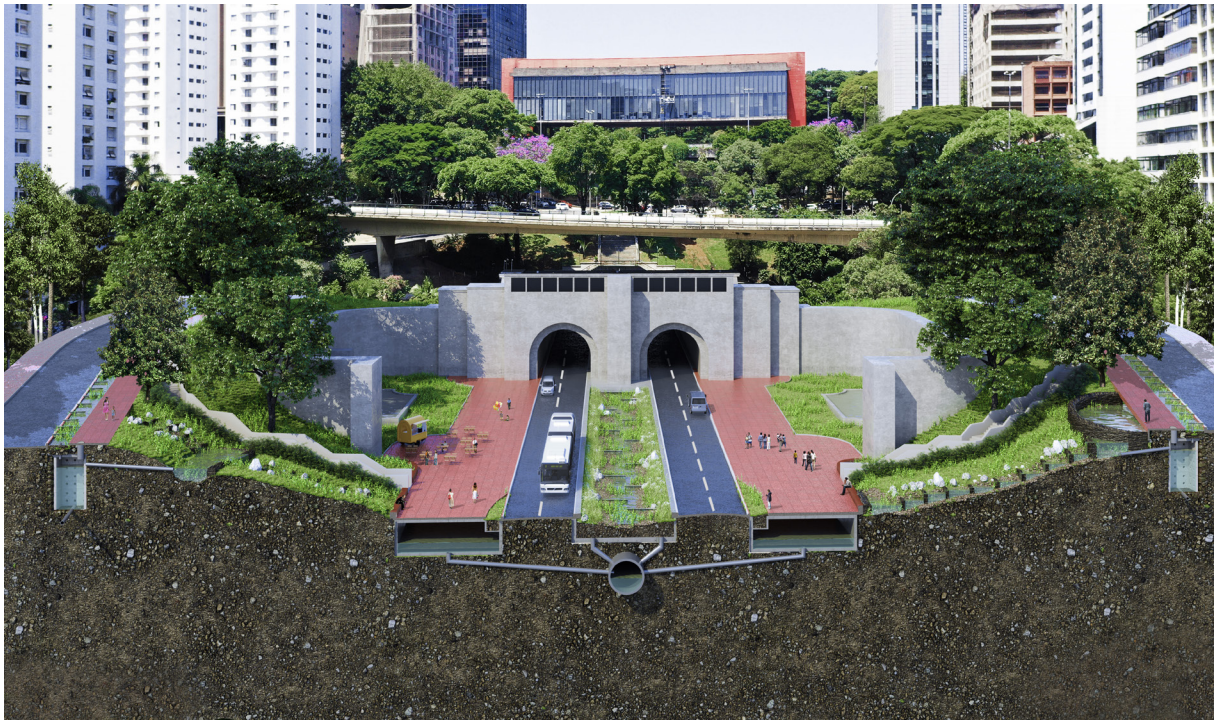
Corte do projeto, destaque para o novo dispositivo de infraestrutura verde: terraço de chuva.
